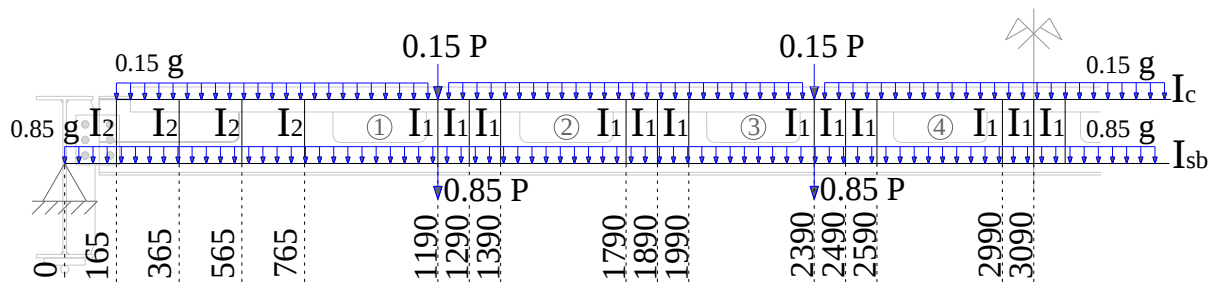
Modelo estrutural simplificado para a viga mista (dimensões em mm)
